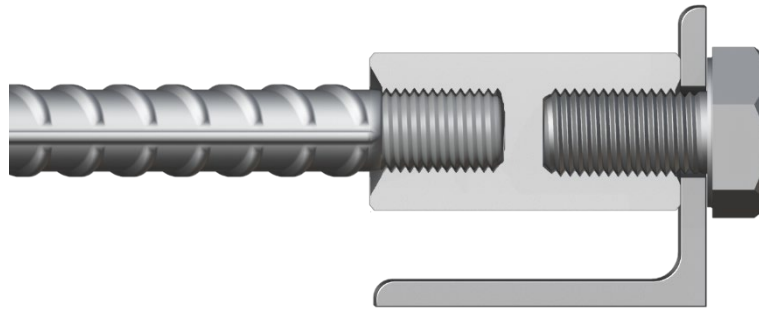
Резьбовое соединение арматуры под метрический болт
